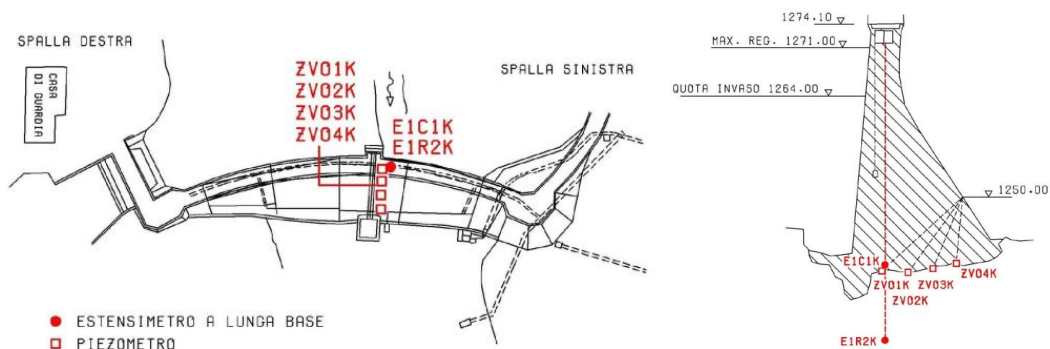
Planimetria e sezione con l'indicazione dell'ubicazione degli estensimetri [2][3]
